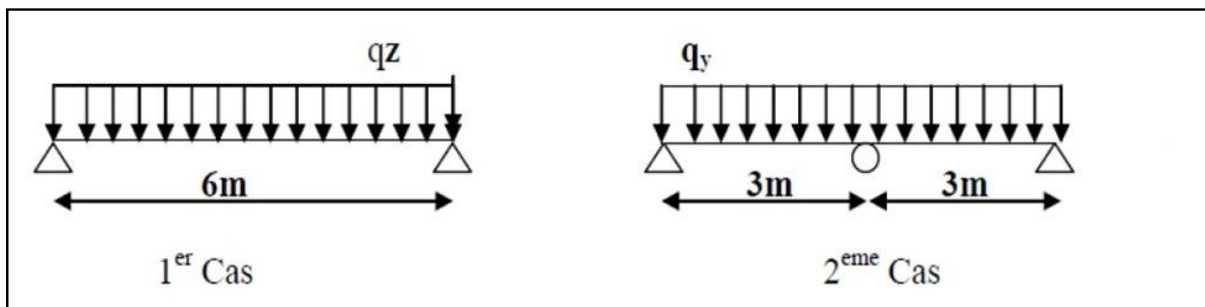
les schémas statiques de la lisse dans les deux plans y-y et z-z.
